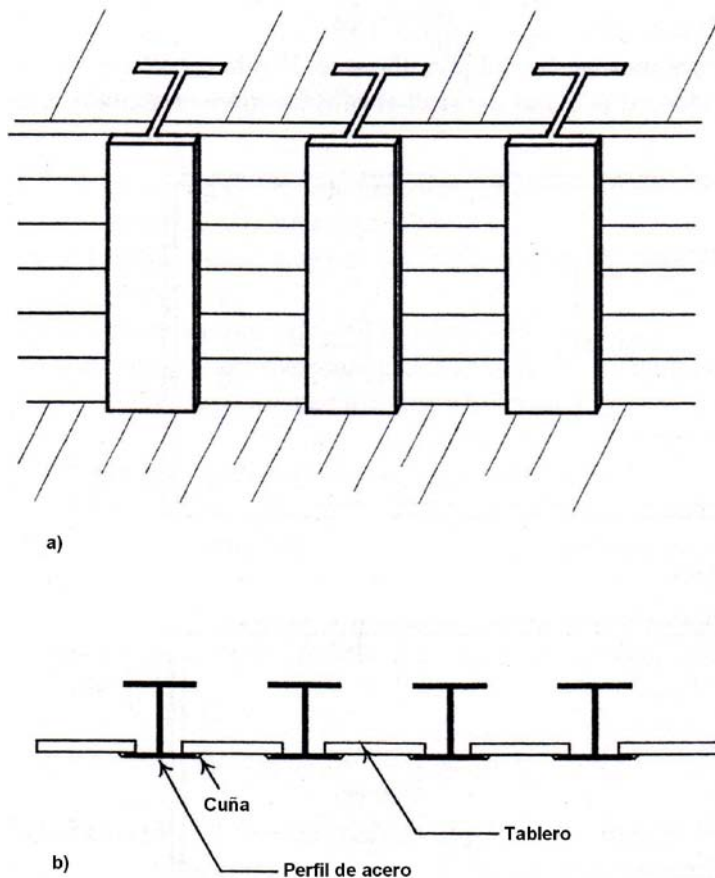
Muro tipo Berlín, a) vista frontal, b) vista en planta (Ou, 2006).
